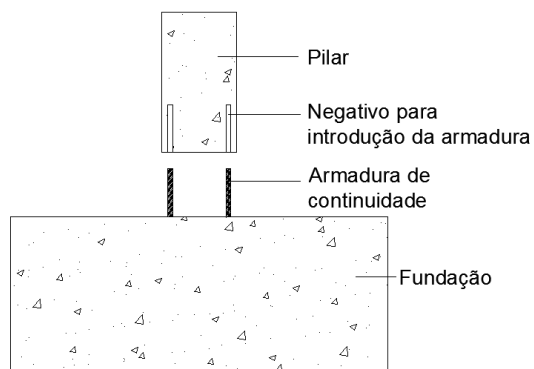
Ligação com armaduras de continuidade salientes da sapata
